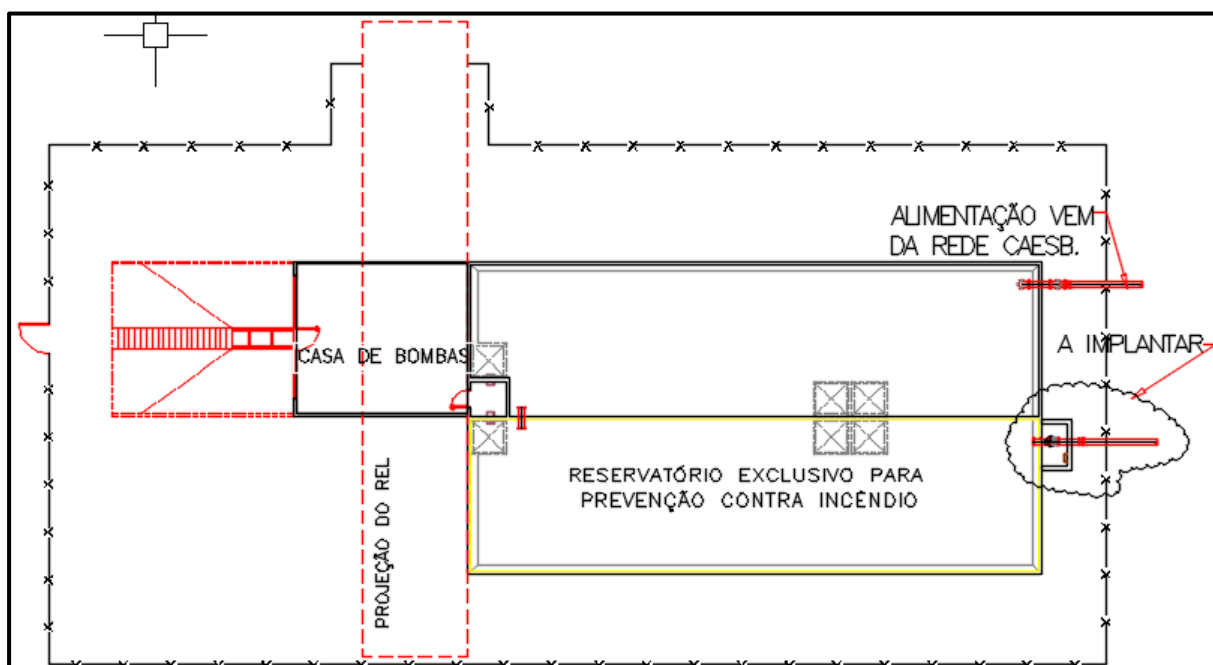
Planta dos reservatórios com as novas instalações (Fonte: Autor)
